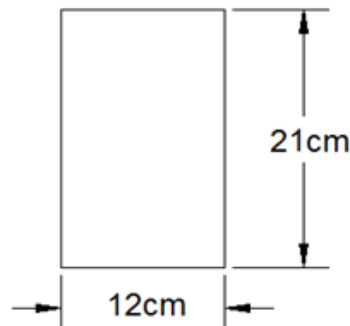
Coupe schématique de la poutrelle (appuis)
